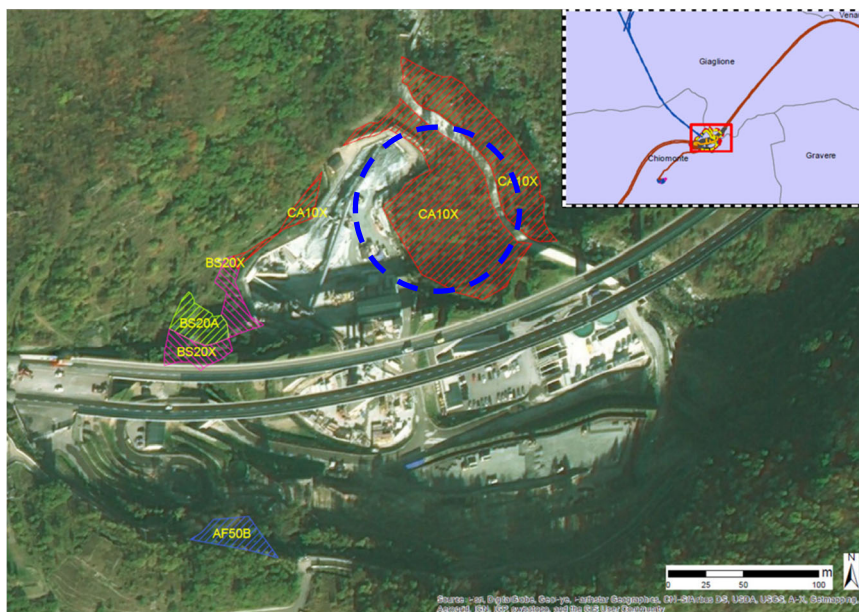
PRV – Estratto Planimetria area cantiere – fasi realizzative
